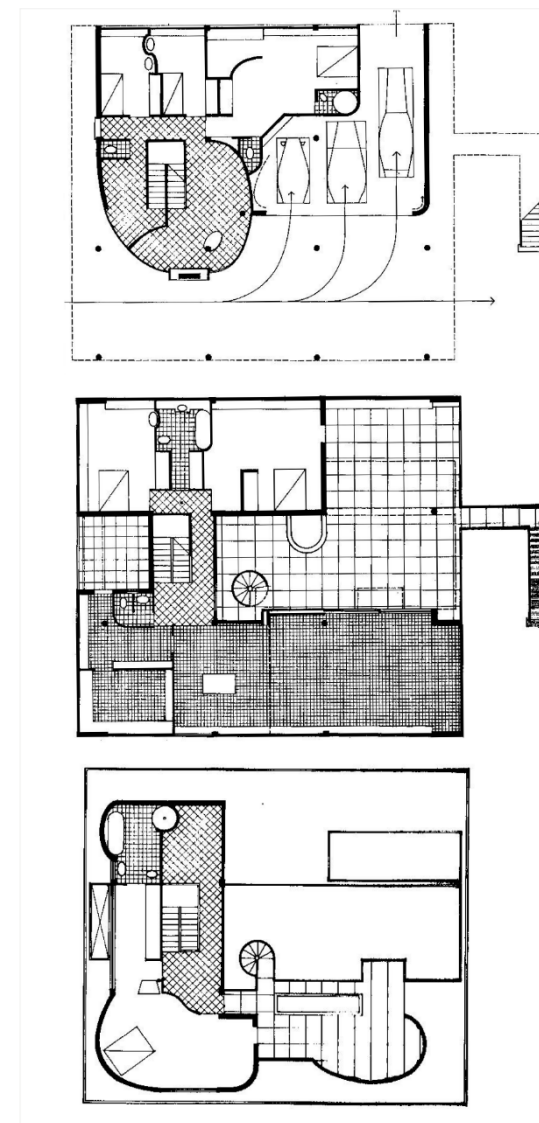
Vila Savoye, segunda proposta. Planta do térreo, primeiro pavimento e segundo pavimento respectivamente, 6 de novembro de 1928. Fonte: Benton, 1984 pg. 198.
